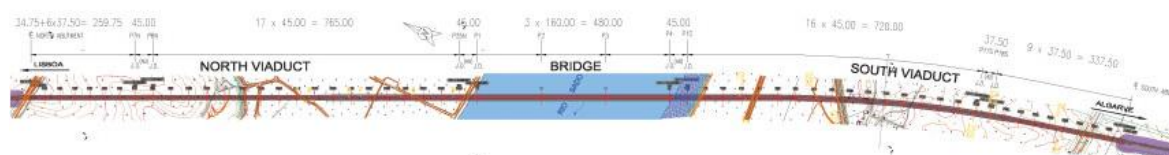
Vista em planta da ponte (adaptado de Reis et al., 2010)
